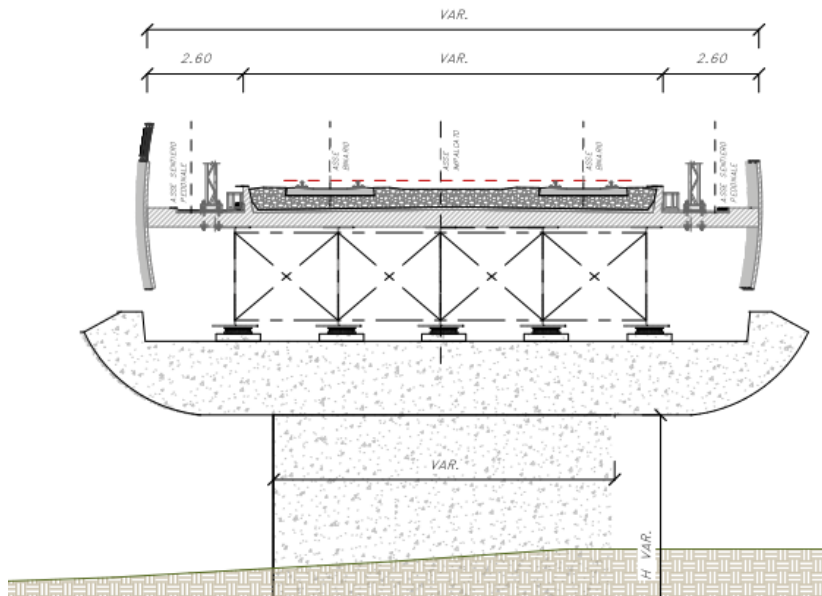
Sezione trasversale tipo: Impalcato a struttura mista acciaio calcestruzzo a doppio binario da pila 18 a pila 20
